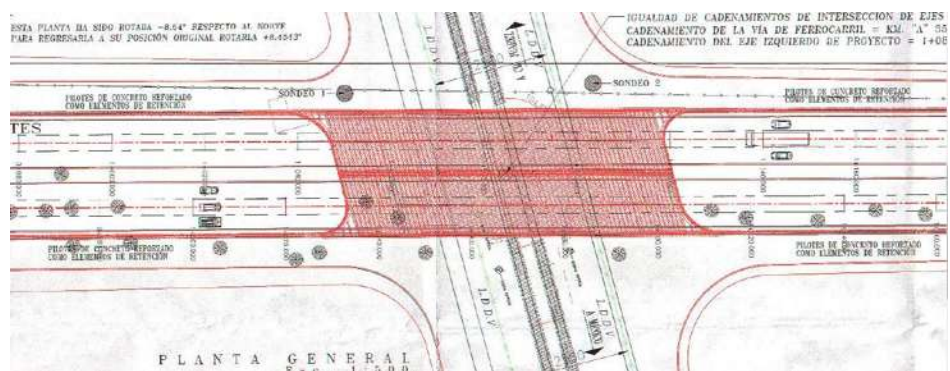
Planta de proyecto con el paso de dos vías a nivel.
